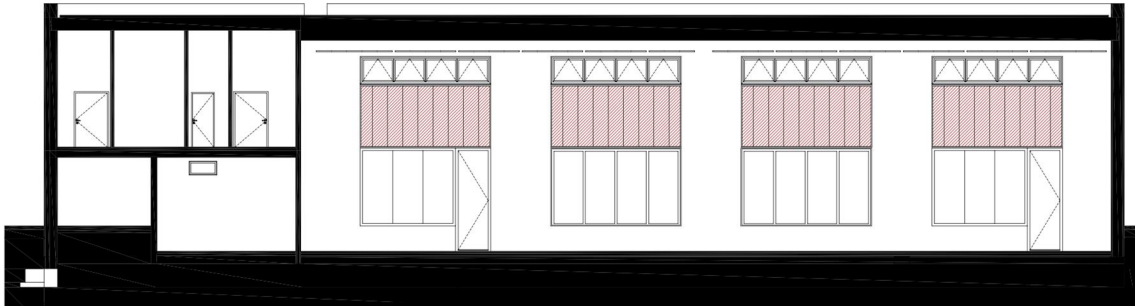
Prospetto Sud con indicazione dei pannelli a parete (pannelli in fibra di legno mineralizzata con retrostante pannello in lana di roccia spess. 75mm)
